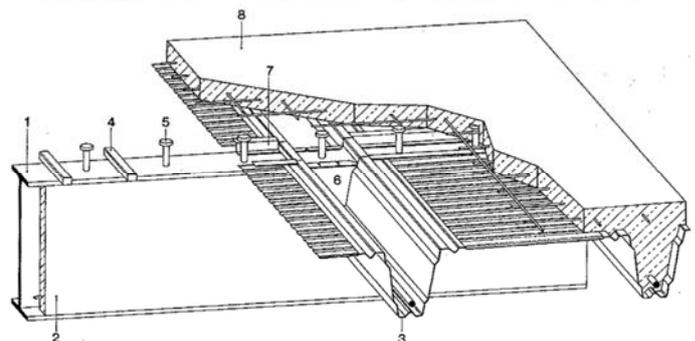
Stahlfachdecke mit tiefen Trapezprofilen
